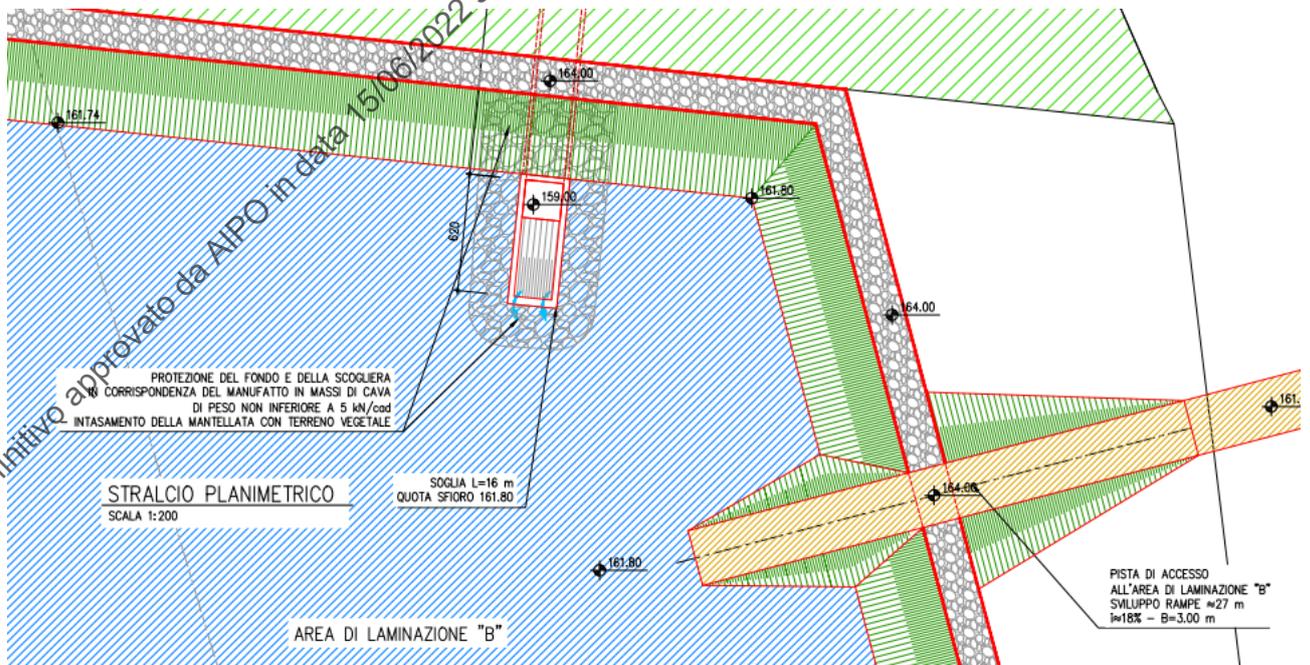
sbocco dell'alimentazione dell'area di laminazione B. Estratto da Tav. 13.1
